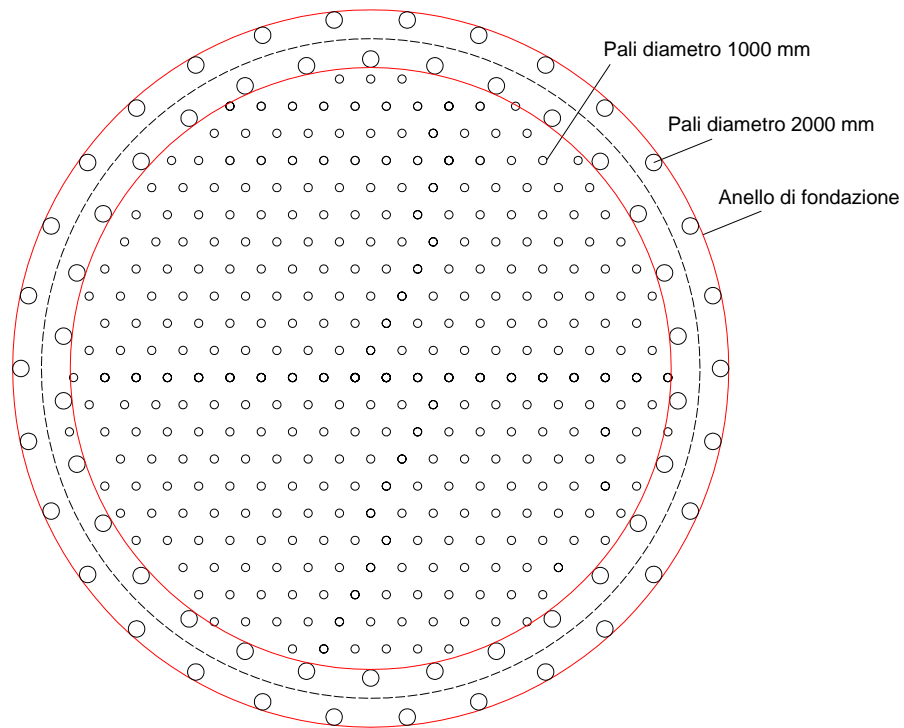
Disposizione della palificata di fondazione di tentativo
